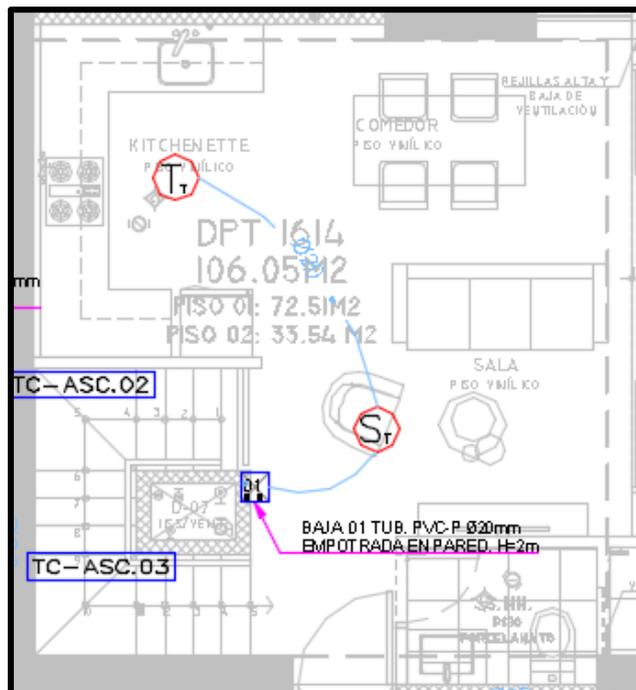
Equipos en departamento de dos pisos (Segunda Planta)
